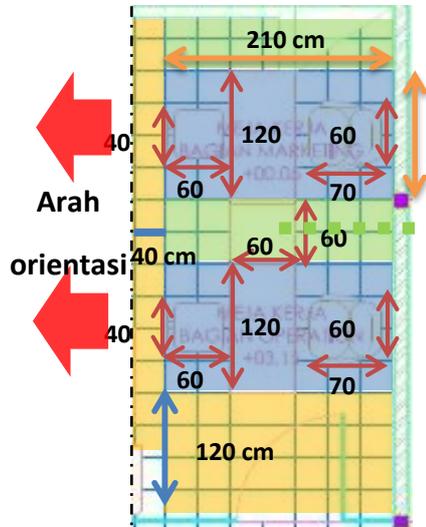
267 Denah ruang tamu lantai 1 objek A
